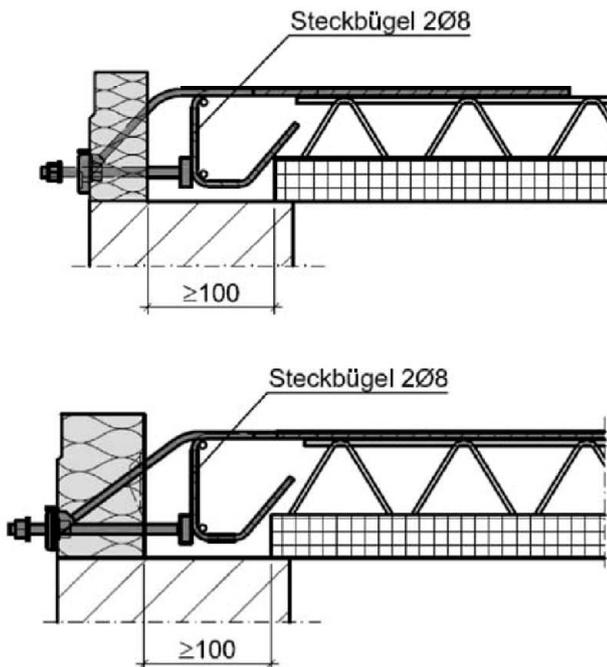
Bauseitige Anschlussbewehrung für Schöck Isokorb® XT Typ SK-MM2-VV1 und T Typ SK-MM2-VV2
